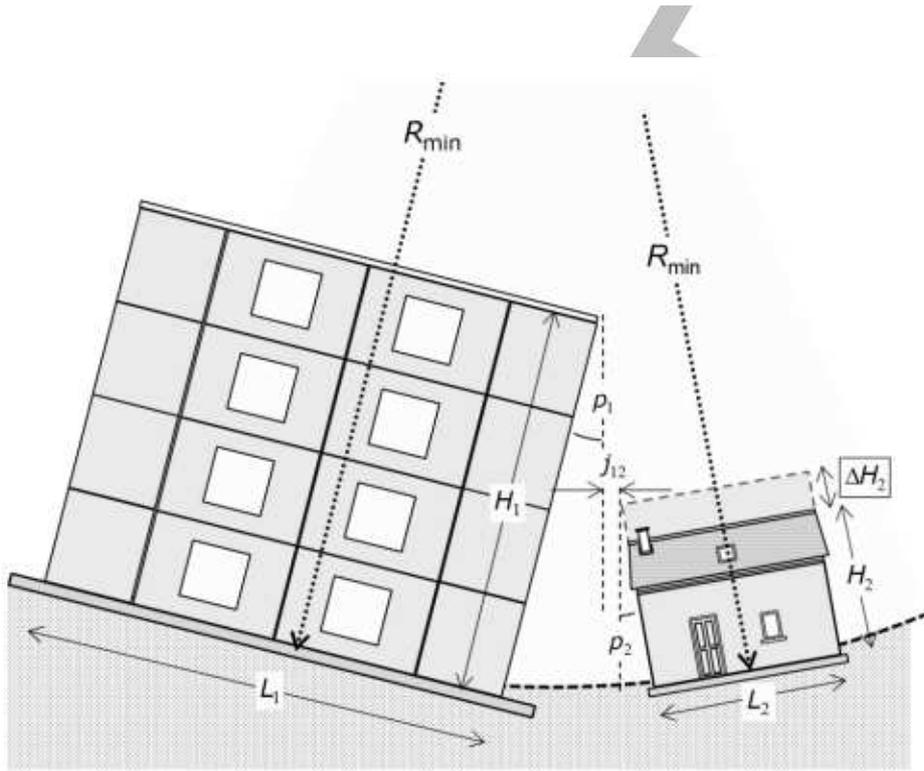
diminution de la distance d'isolement engendrée par la surélévation
